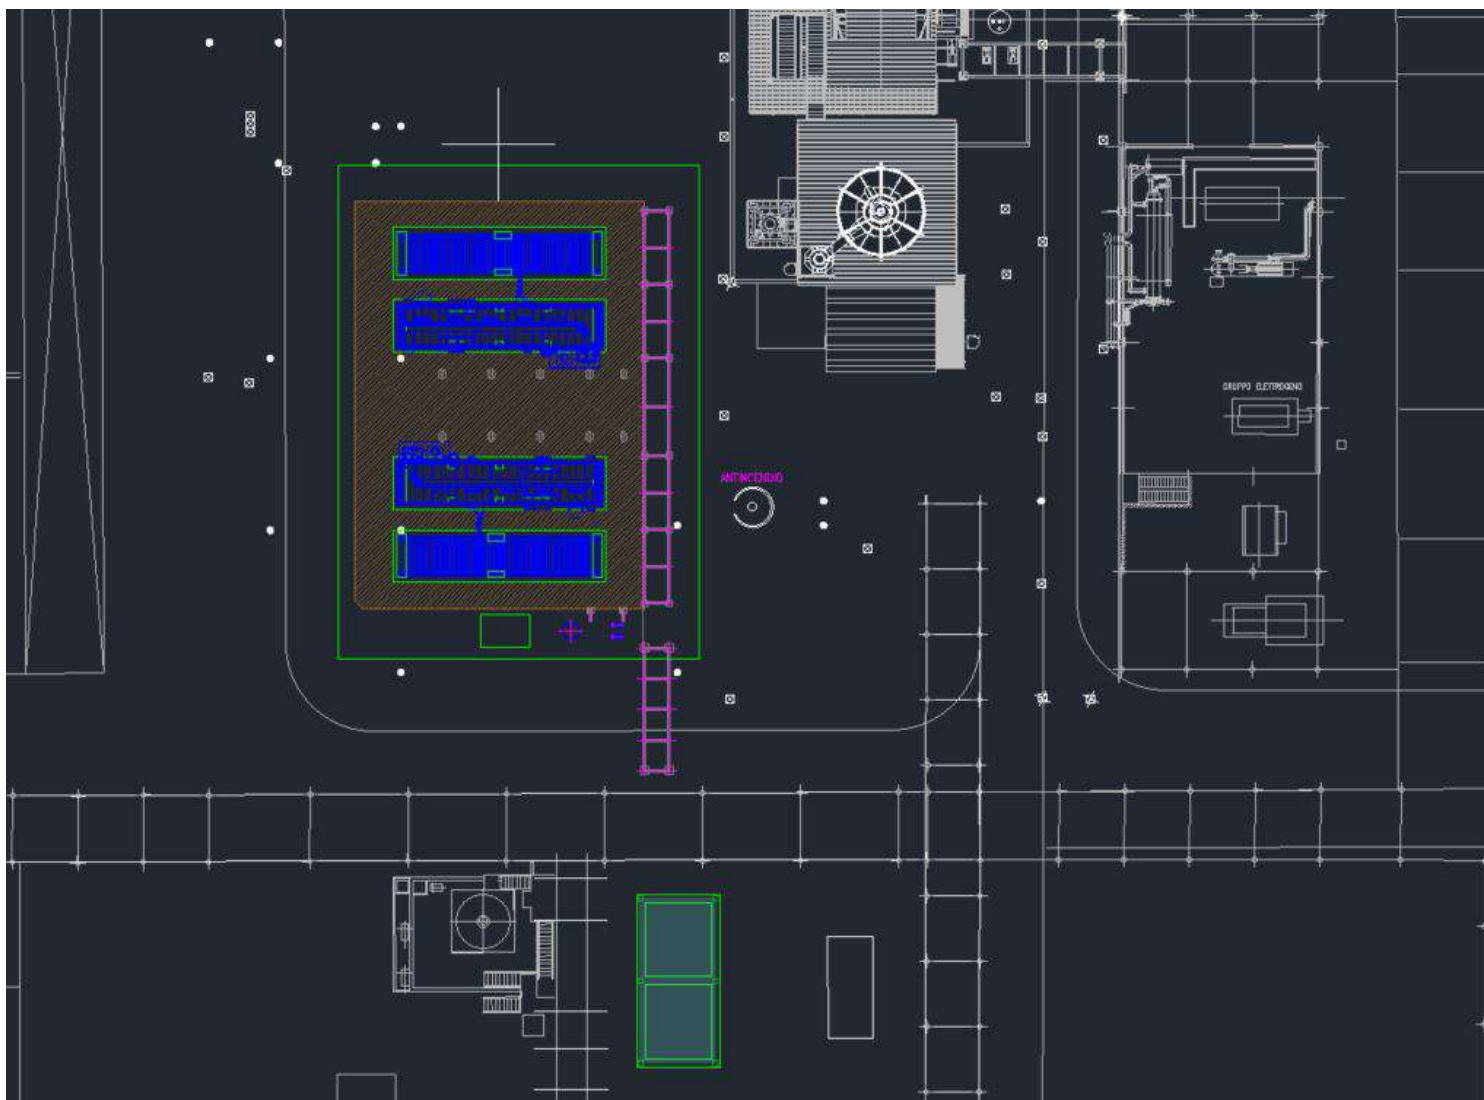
Planimetria di progetto (Estratto dalla Tavola 5 – Planimetria generale, Elaborato 07)
